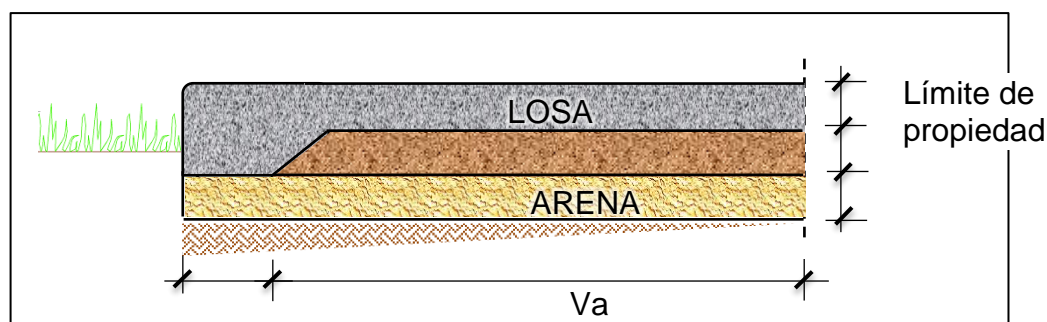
Detalle de vereda adyacente a jardín.
